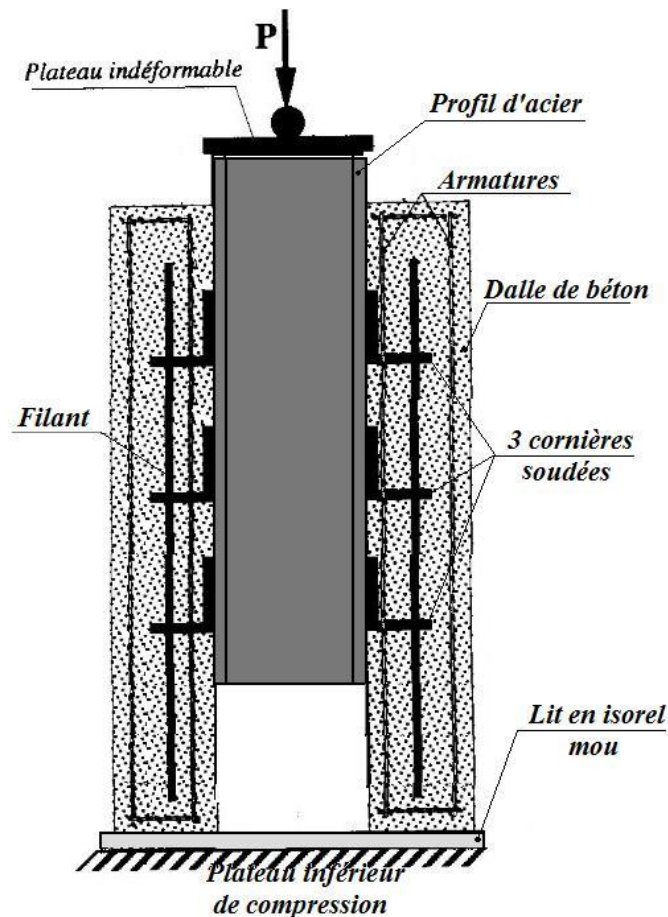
Corps d'essai Push-Out sur un connecteur type cornière avec filant. [15]
